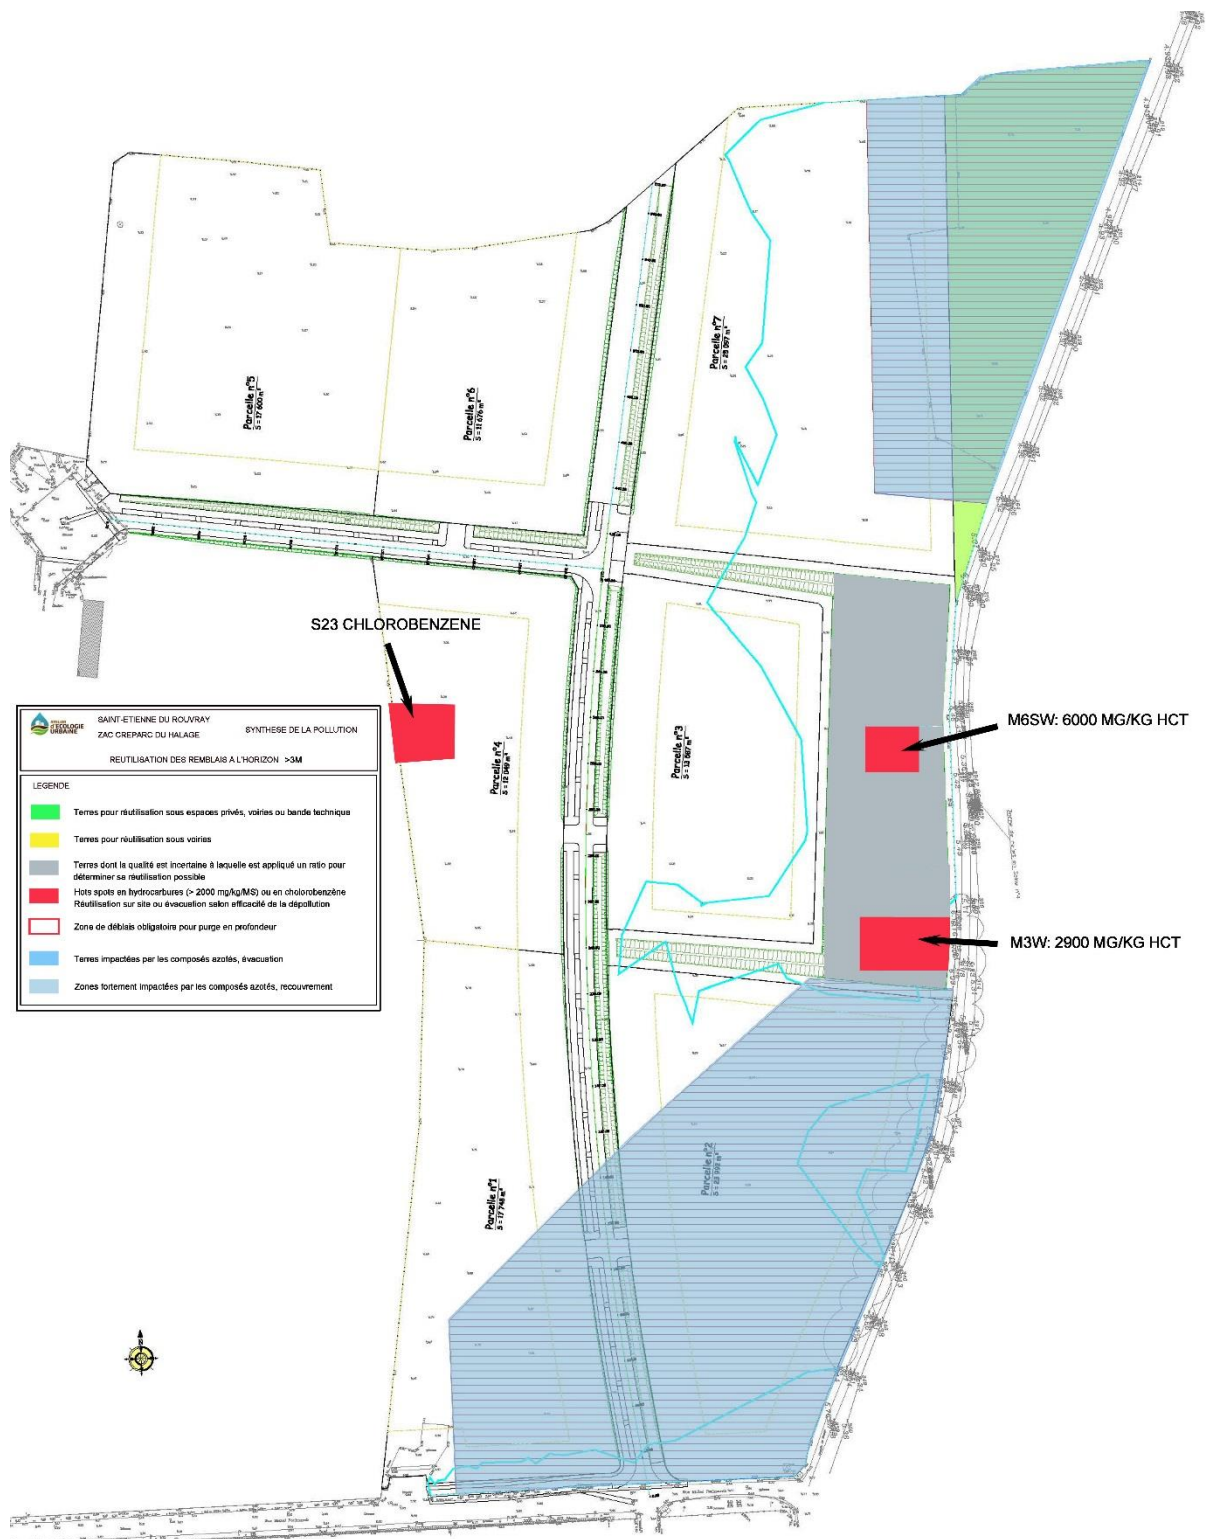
Terrassement et purges sur la profondeur 3-4m
